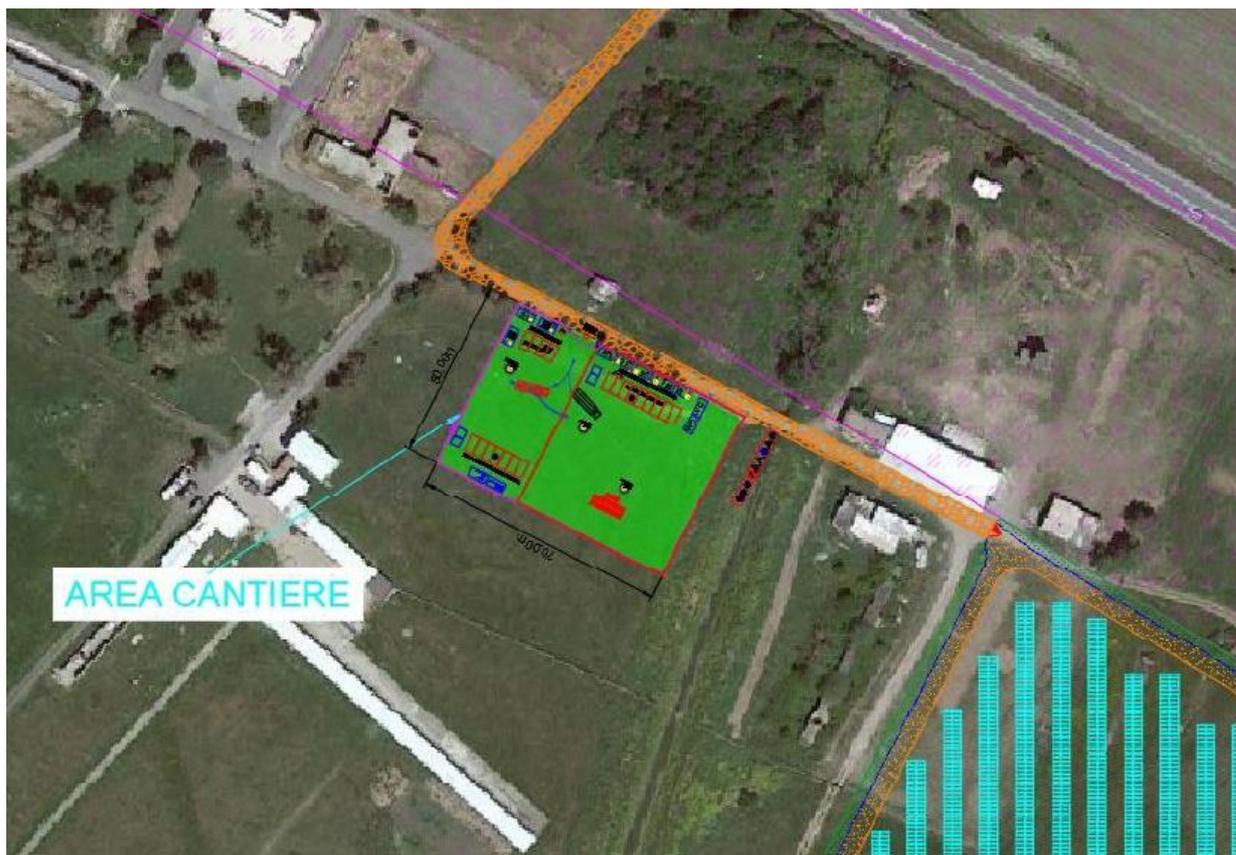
Stralcio su ortofoto con localizzazione della posizione dell'area temporanea di cantiere.
